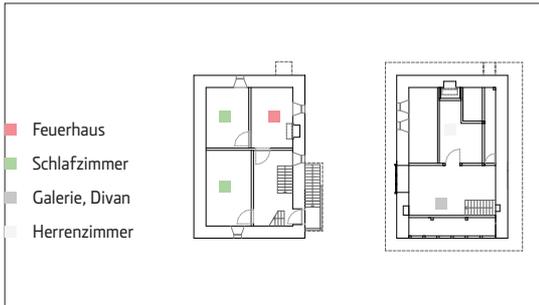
Doli, Flamur: Vernacular Architecture of Kosovo, Grundriss des ersten und zweiten Stockwerks des Turmhauses von Lah Selmoni, 1836, Carrabre, Kulla mit hölzerner Galerie.
